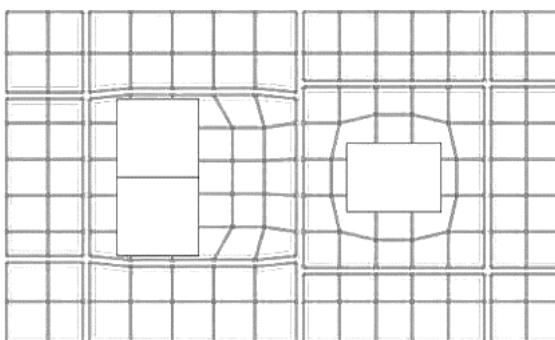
Схема плити перекриття по балках. Порівняльний аналіз
